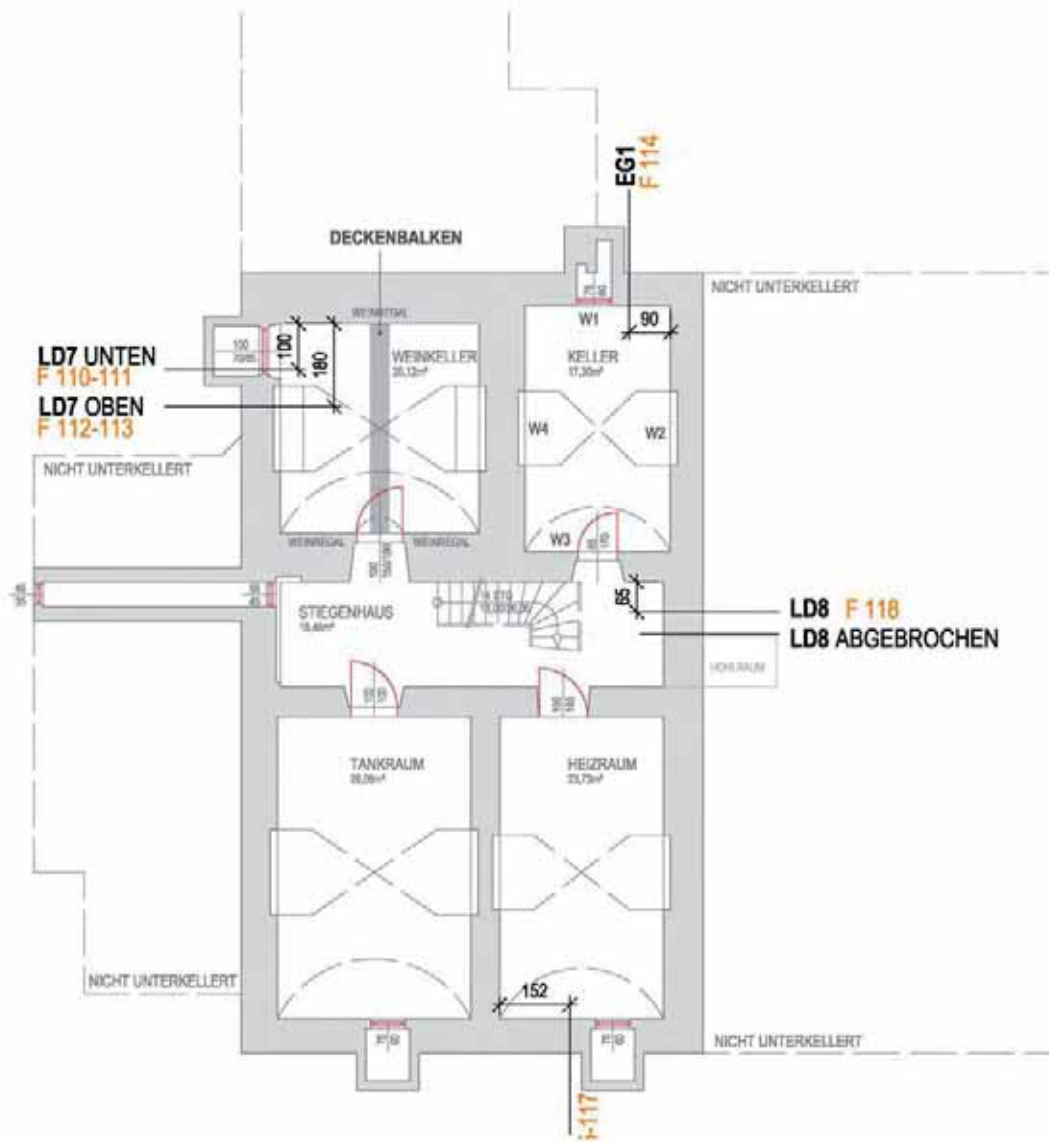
Plan A3 – 4: Position der Achsen 7 (LD 7) bis 8 (LD 8) im Grundriss
